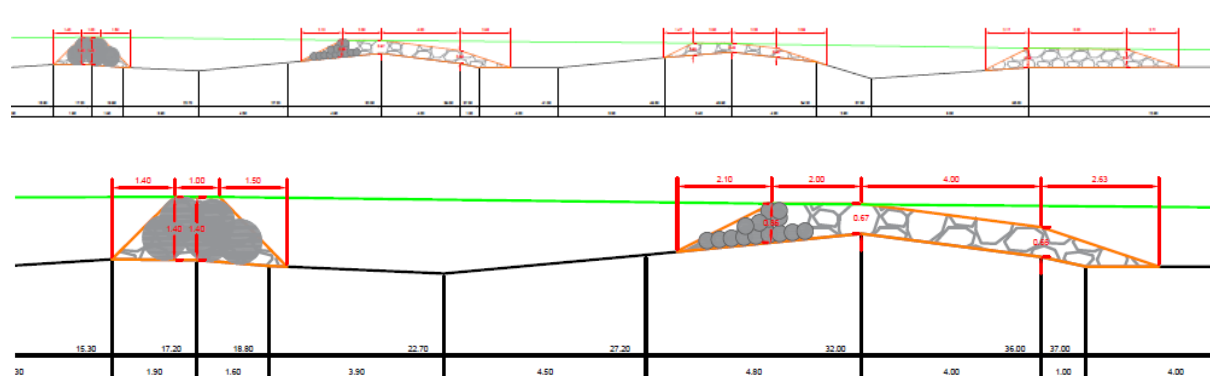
Plan complet de maîtrise d'œuvre pour le site du Bouillant et un zoom fait sur la première partie de ce plan — en mètre (Auteur : Illona Doyon)
